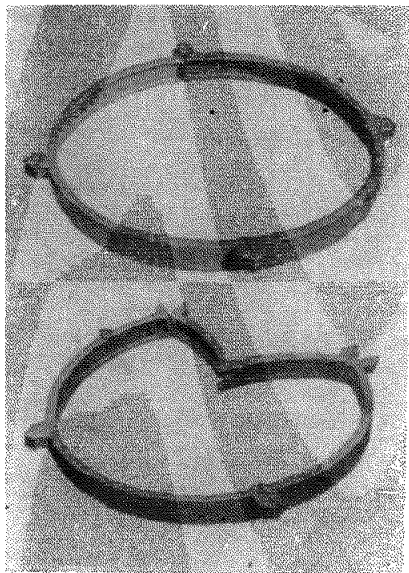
Распорное кольцо каркасно-пластинчатой крепи
